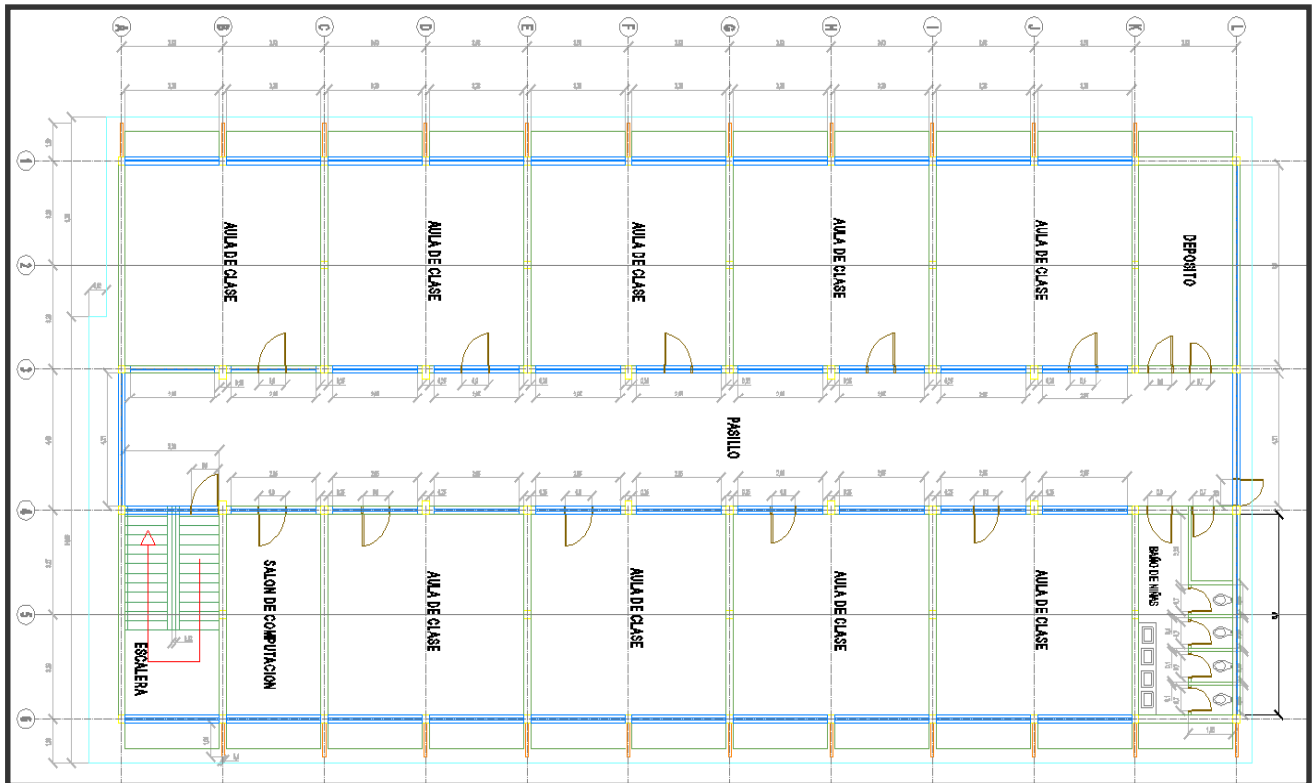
Plano de Arquitectura de la Planta Baja de la U.E. Dr. Lisandro Lecuna.
